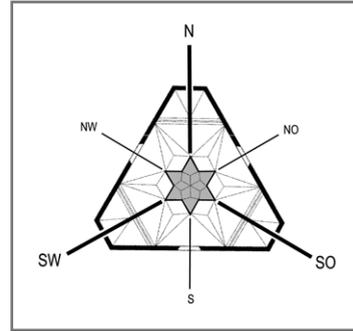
Bruck an der Mur, Heiligeistkirche, Grundriss mit Achsen-Stern. Bezeichnungen nach den Himmelsrichtungen (innerer Stern hervorgehoben).
